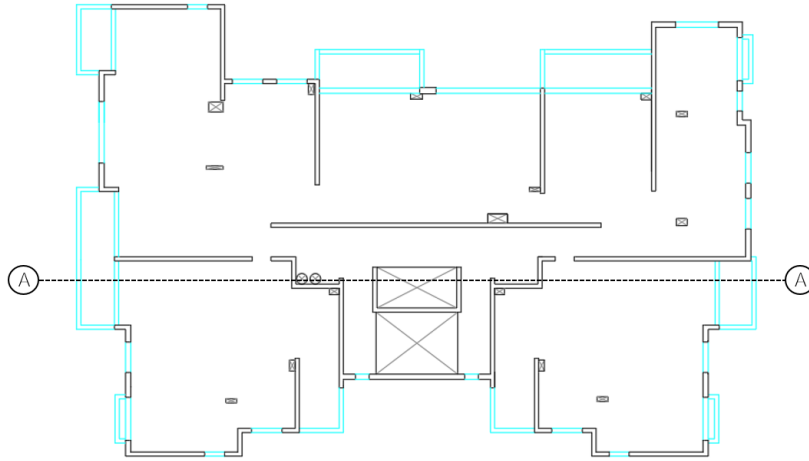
Planta de piso tipo de edificio Antígona con corte en eje A-A donde se posicionan los instrumentos de medición.
